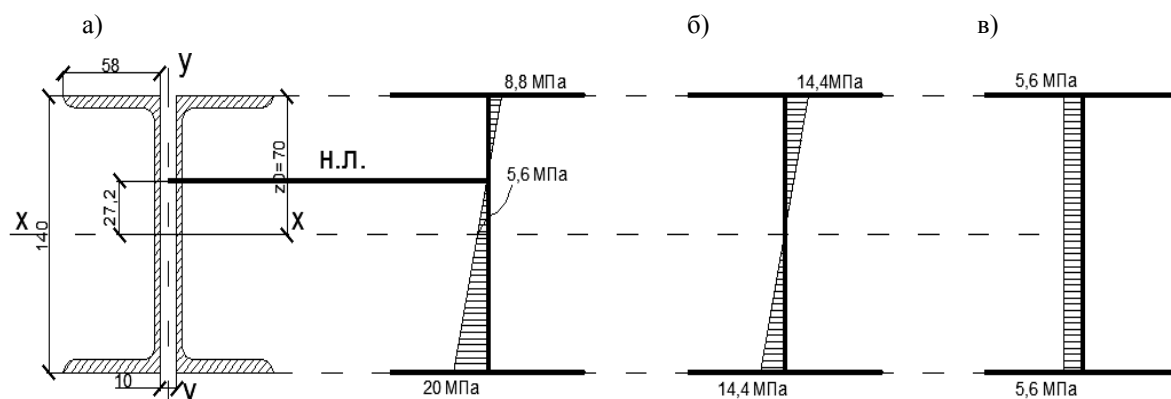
Эпюры напряжений в прогоне № 5 при загрузке испытательной нагрузкой: а – полная эпюра напряжений; б – эпюра напряжений от действия изгибающего момента M ; в – эпюра напряжений от действия продольной силы N
